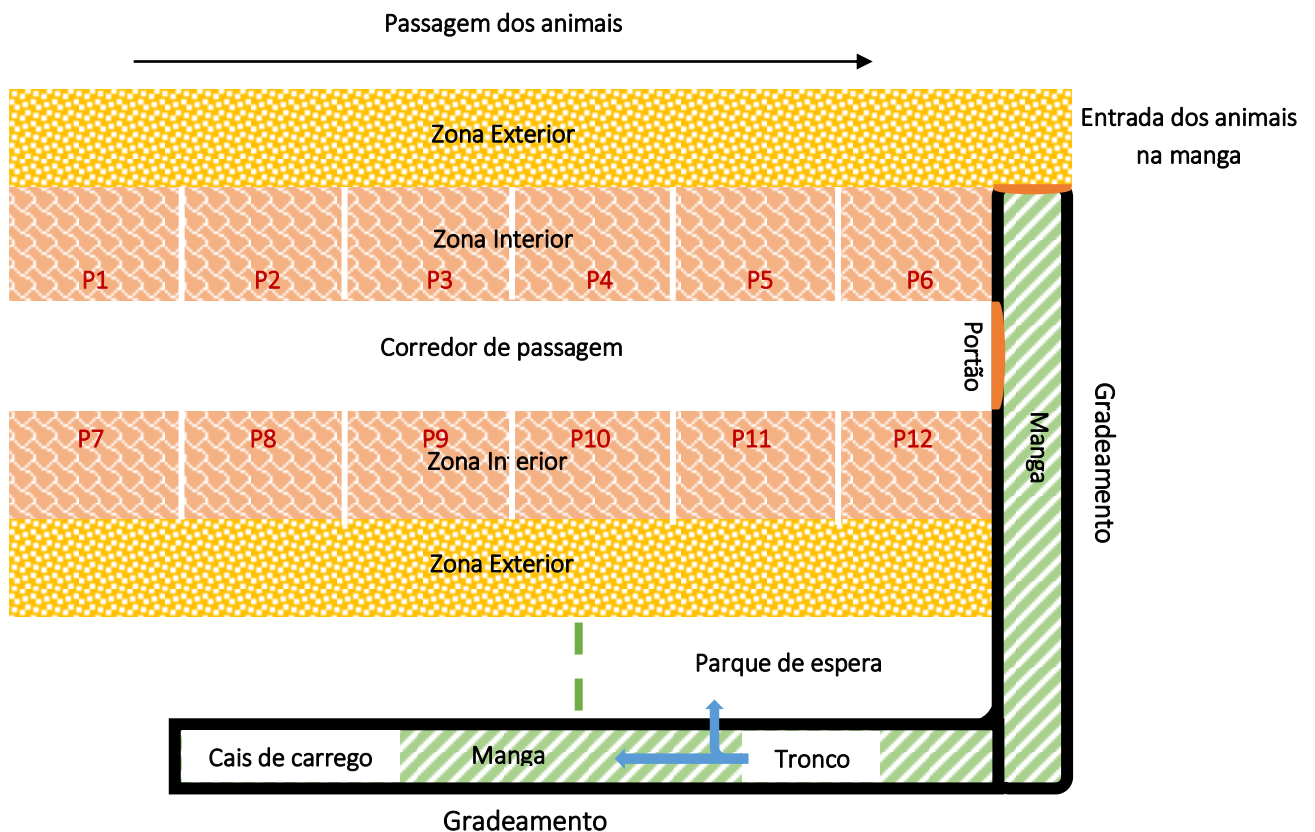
PLANTA DO PAVILHÃO, PARQUES E MANGA (FONTE: AUTOR)
